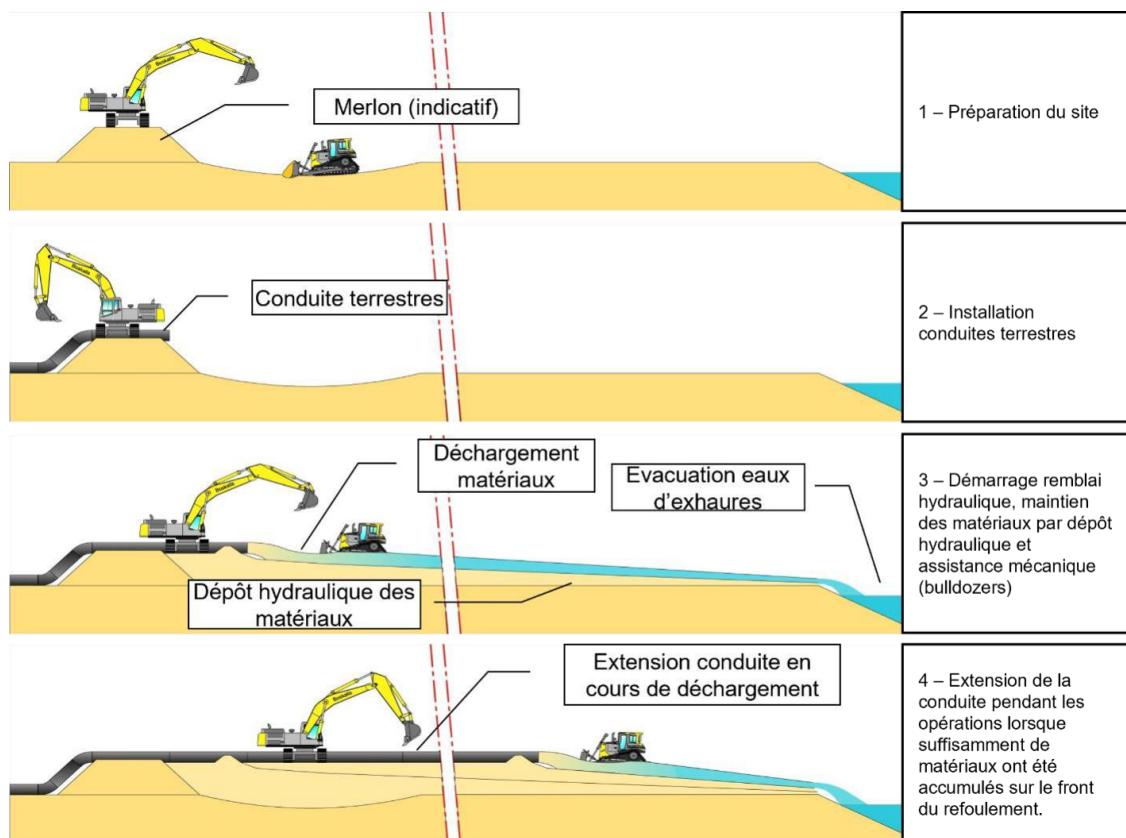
Etapes schématiques d'avancement sur un remblai hydraulique
